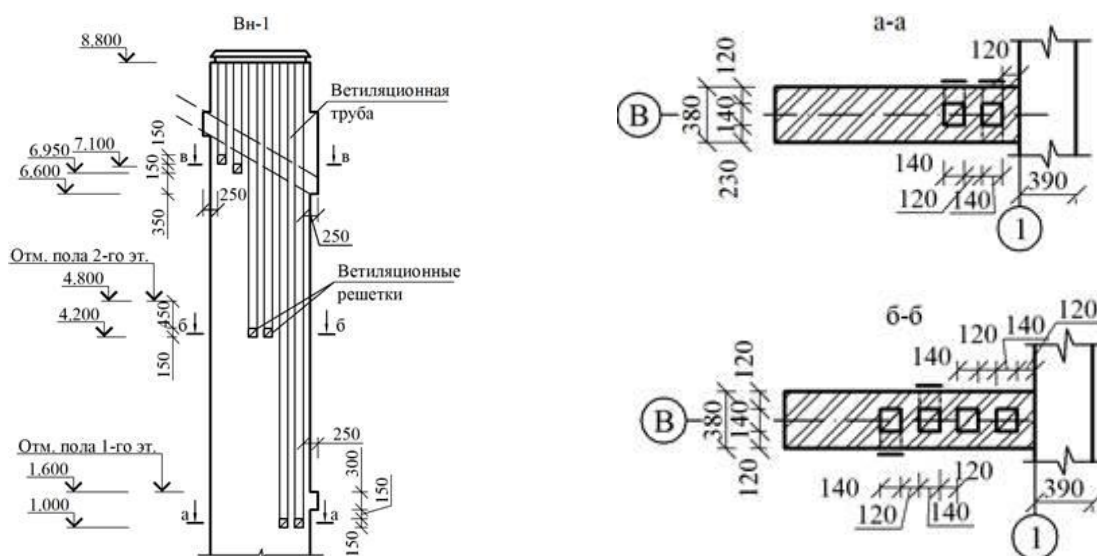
Схема естественной вентиляции жилых зданий без сборных каналов
